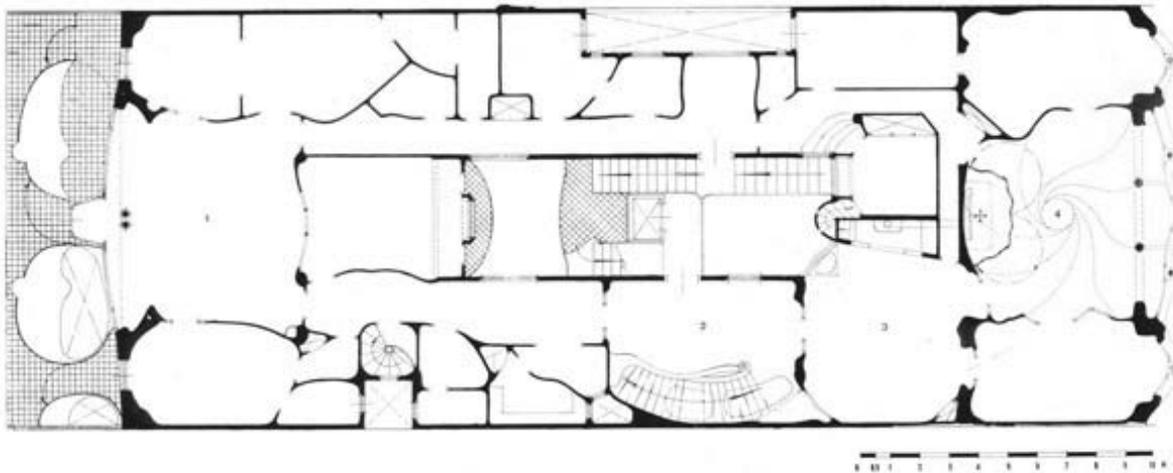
Дом Батло. План 2-го этажа [4, с. 386]
